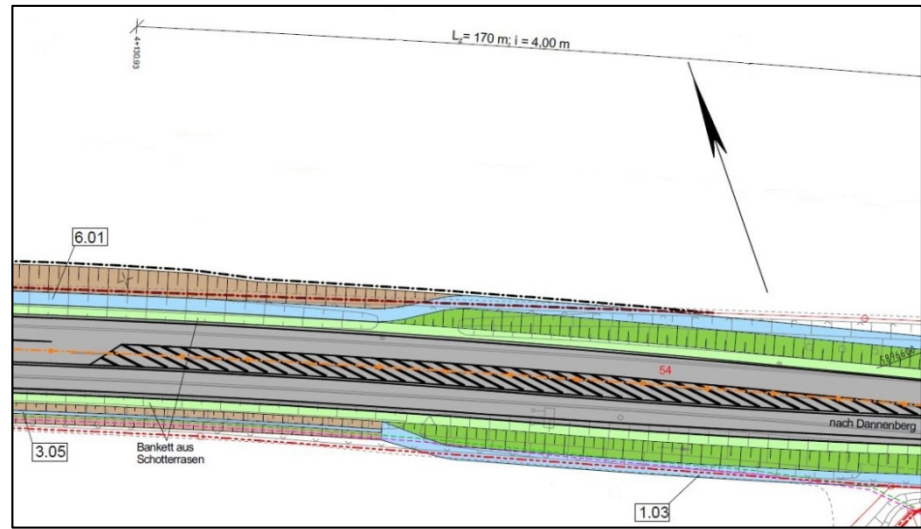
Übergangsbereich anhand Verziehung und Sperrfläche
